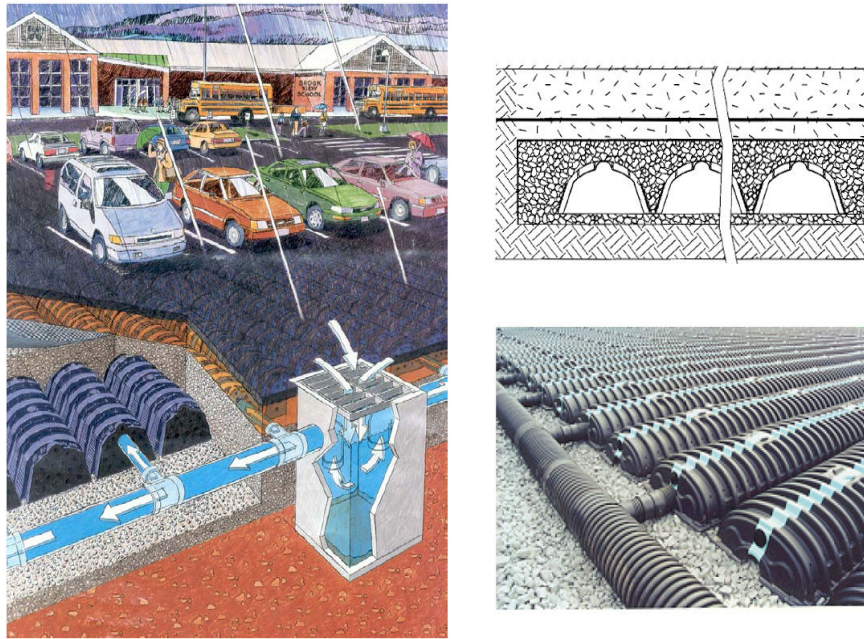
Aplicação do Infiltrador em estacionamento de veículos. As águas pluviais vão para a caixa que as distribui para as câmaras de infiltração.
